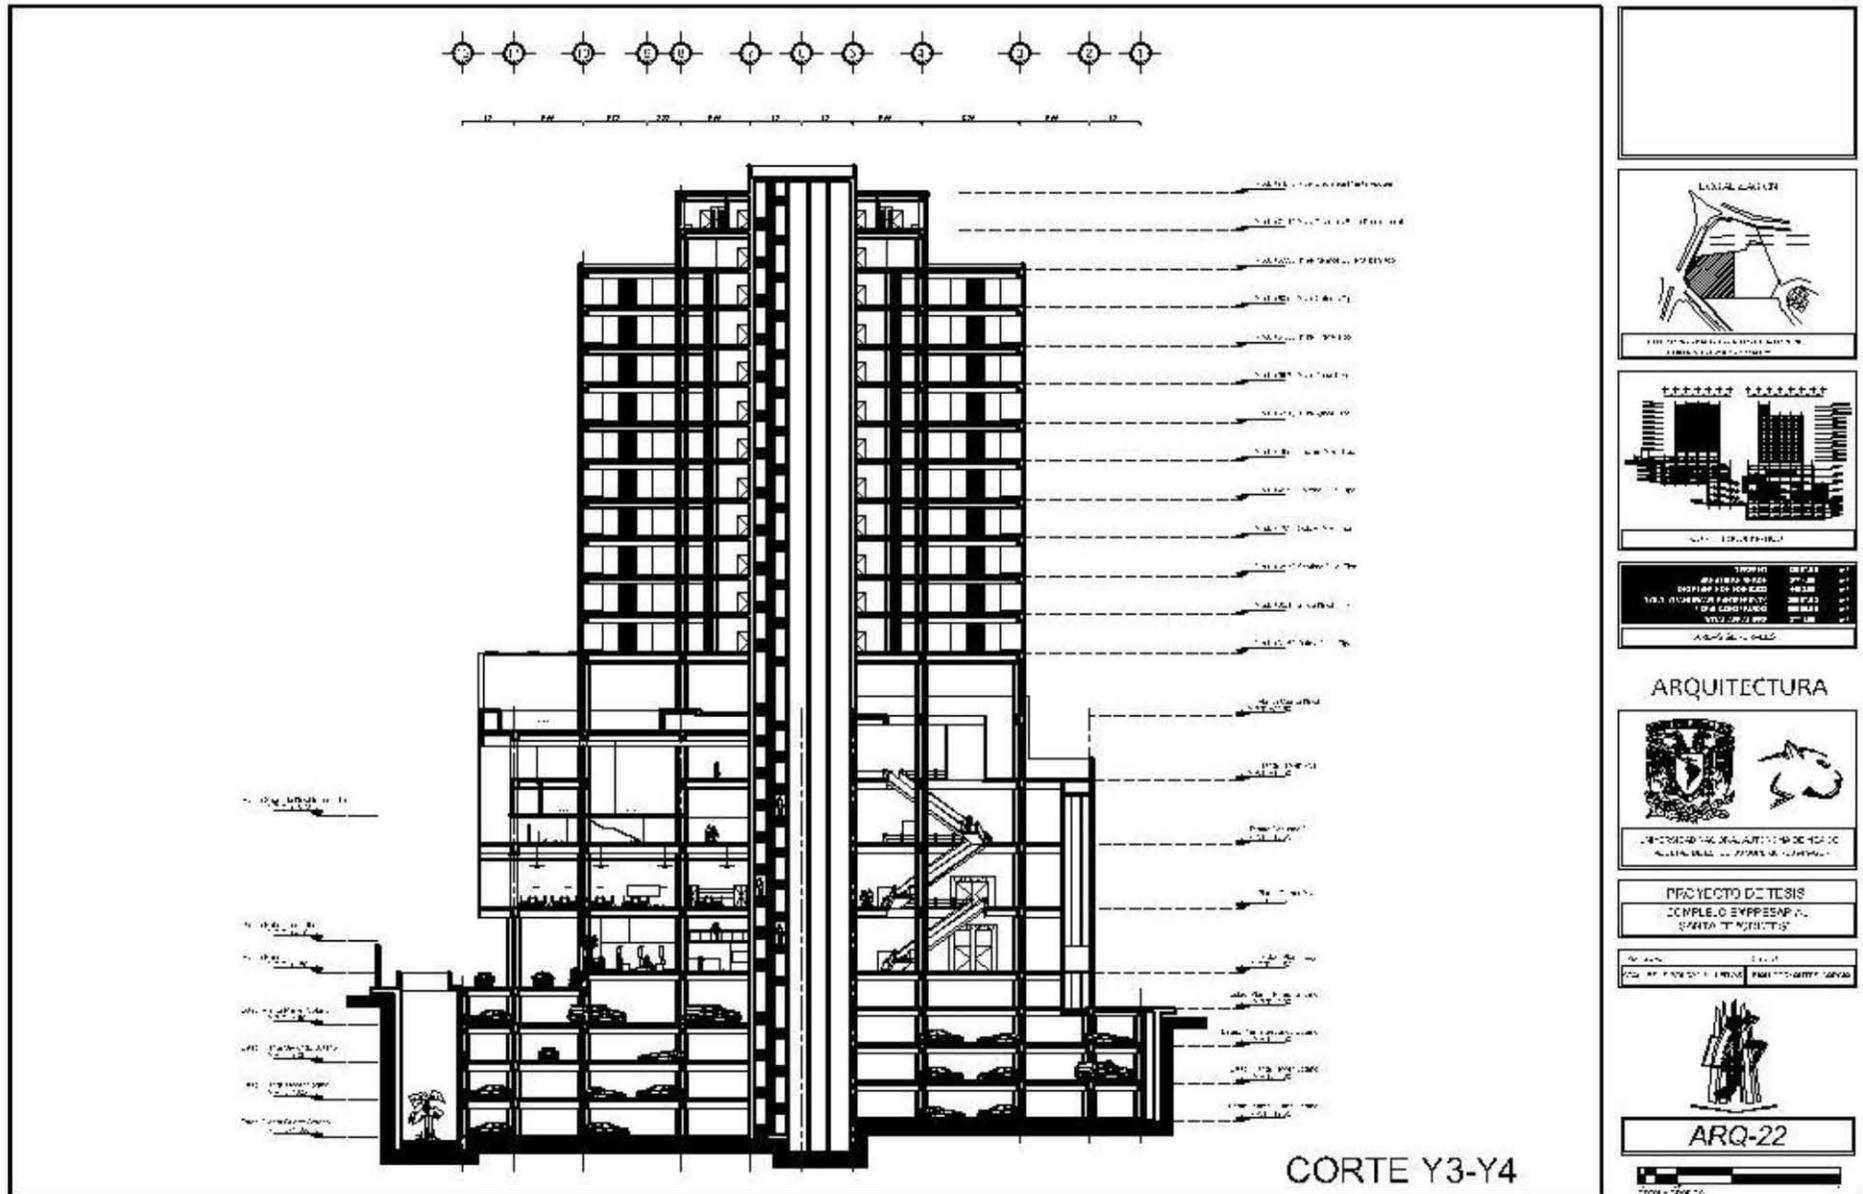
Plano ARQ-22; Corte Y3-Y4 Hotel y Centro Comercial. Edición propia.
